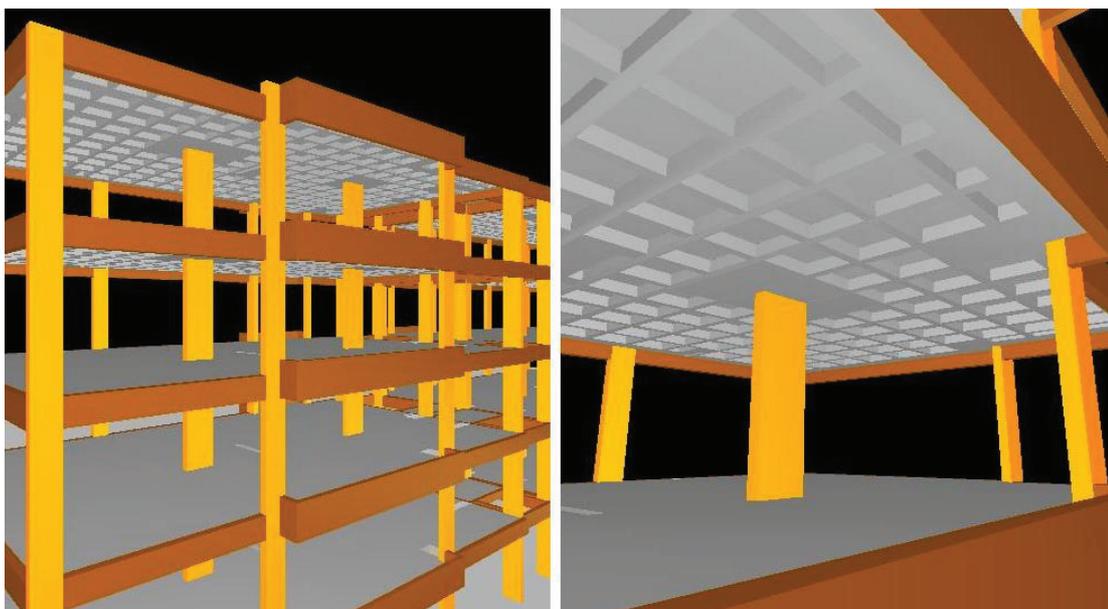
perspectiva dos pavimentos tipo da estrutura em laje nervurada com blocos de EPS
